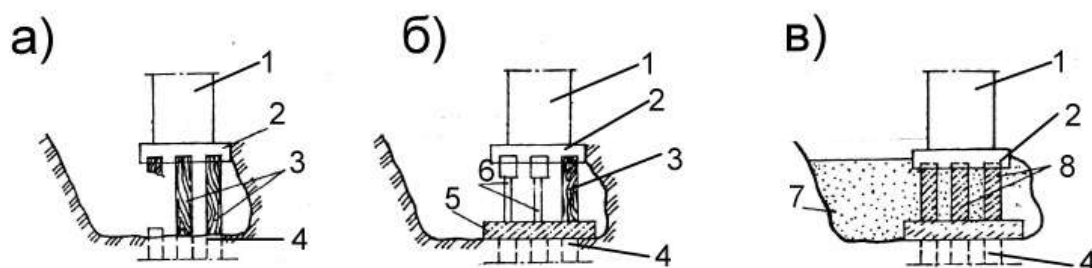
Підсилення фундаментів заміною дерев'яних паль на залізобетонні стовпчики:
